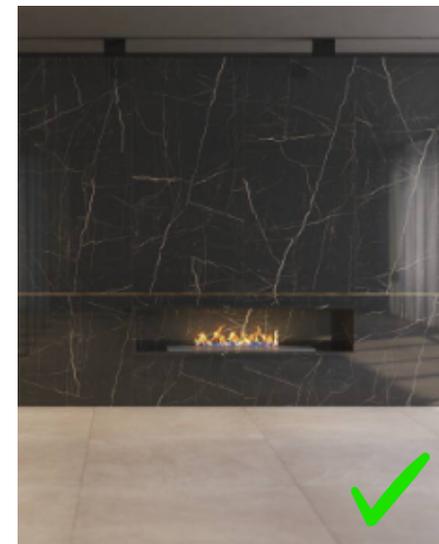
Chimenea tipo fire pit con pared externa y nicho interno revestido en porcelanato.
